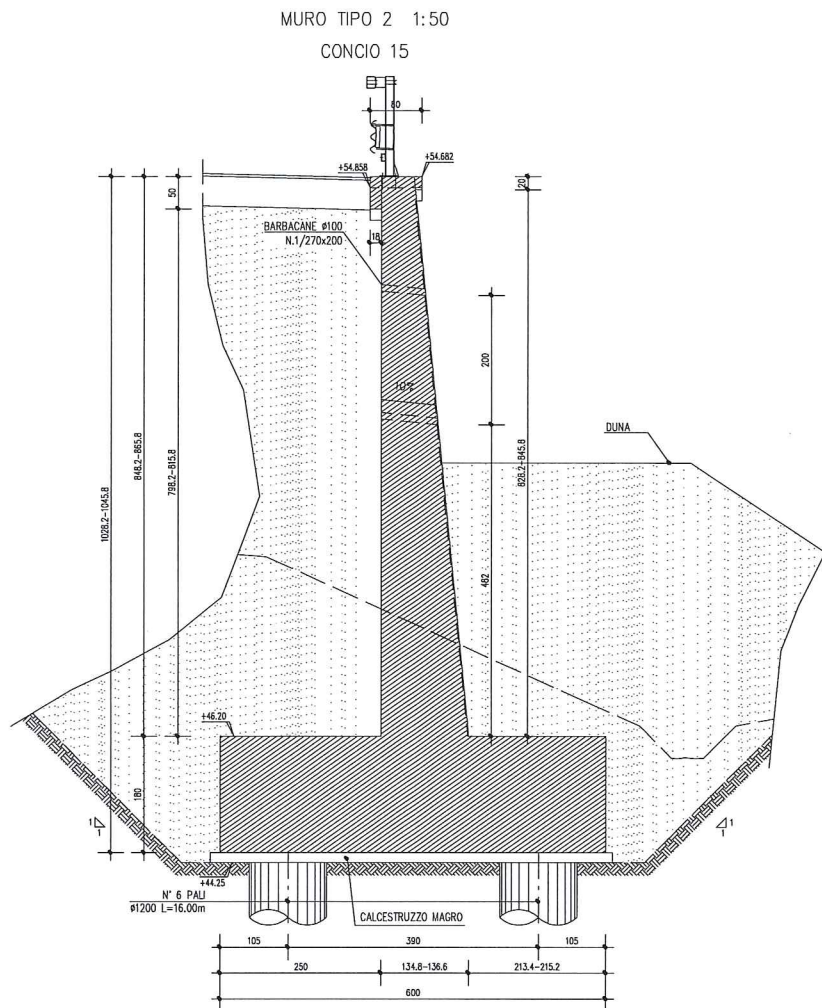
Sezione Tipo - Muro 2 Concio 15
